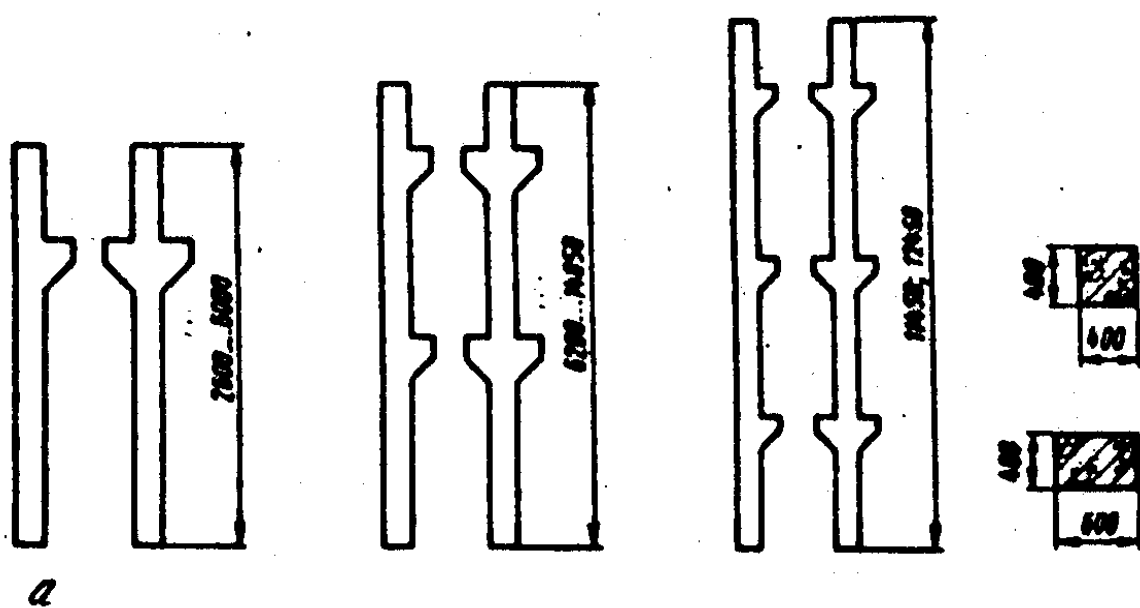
Залізобетонні колони багатоповерхових будівель
